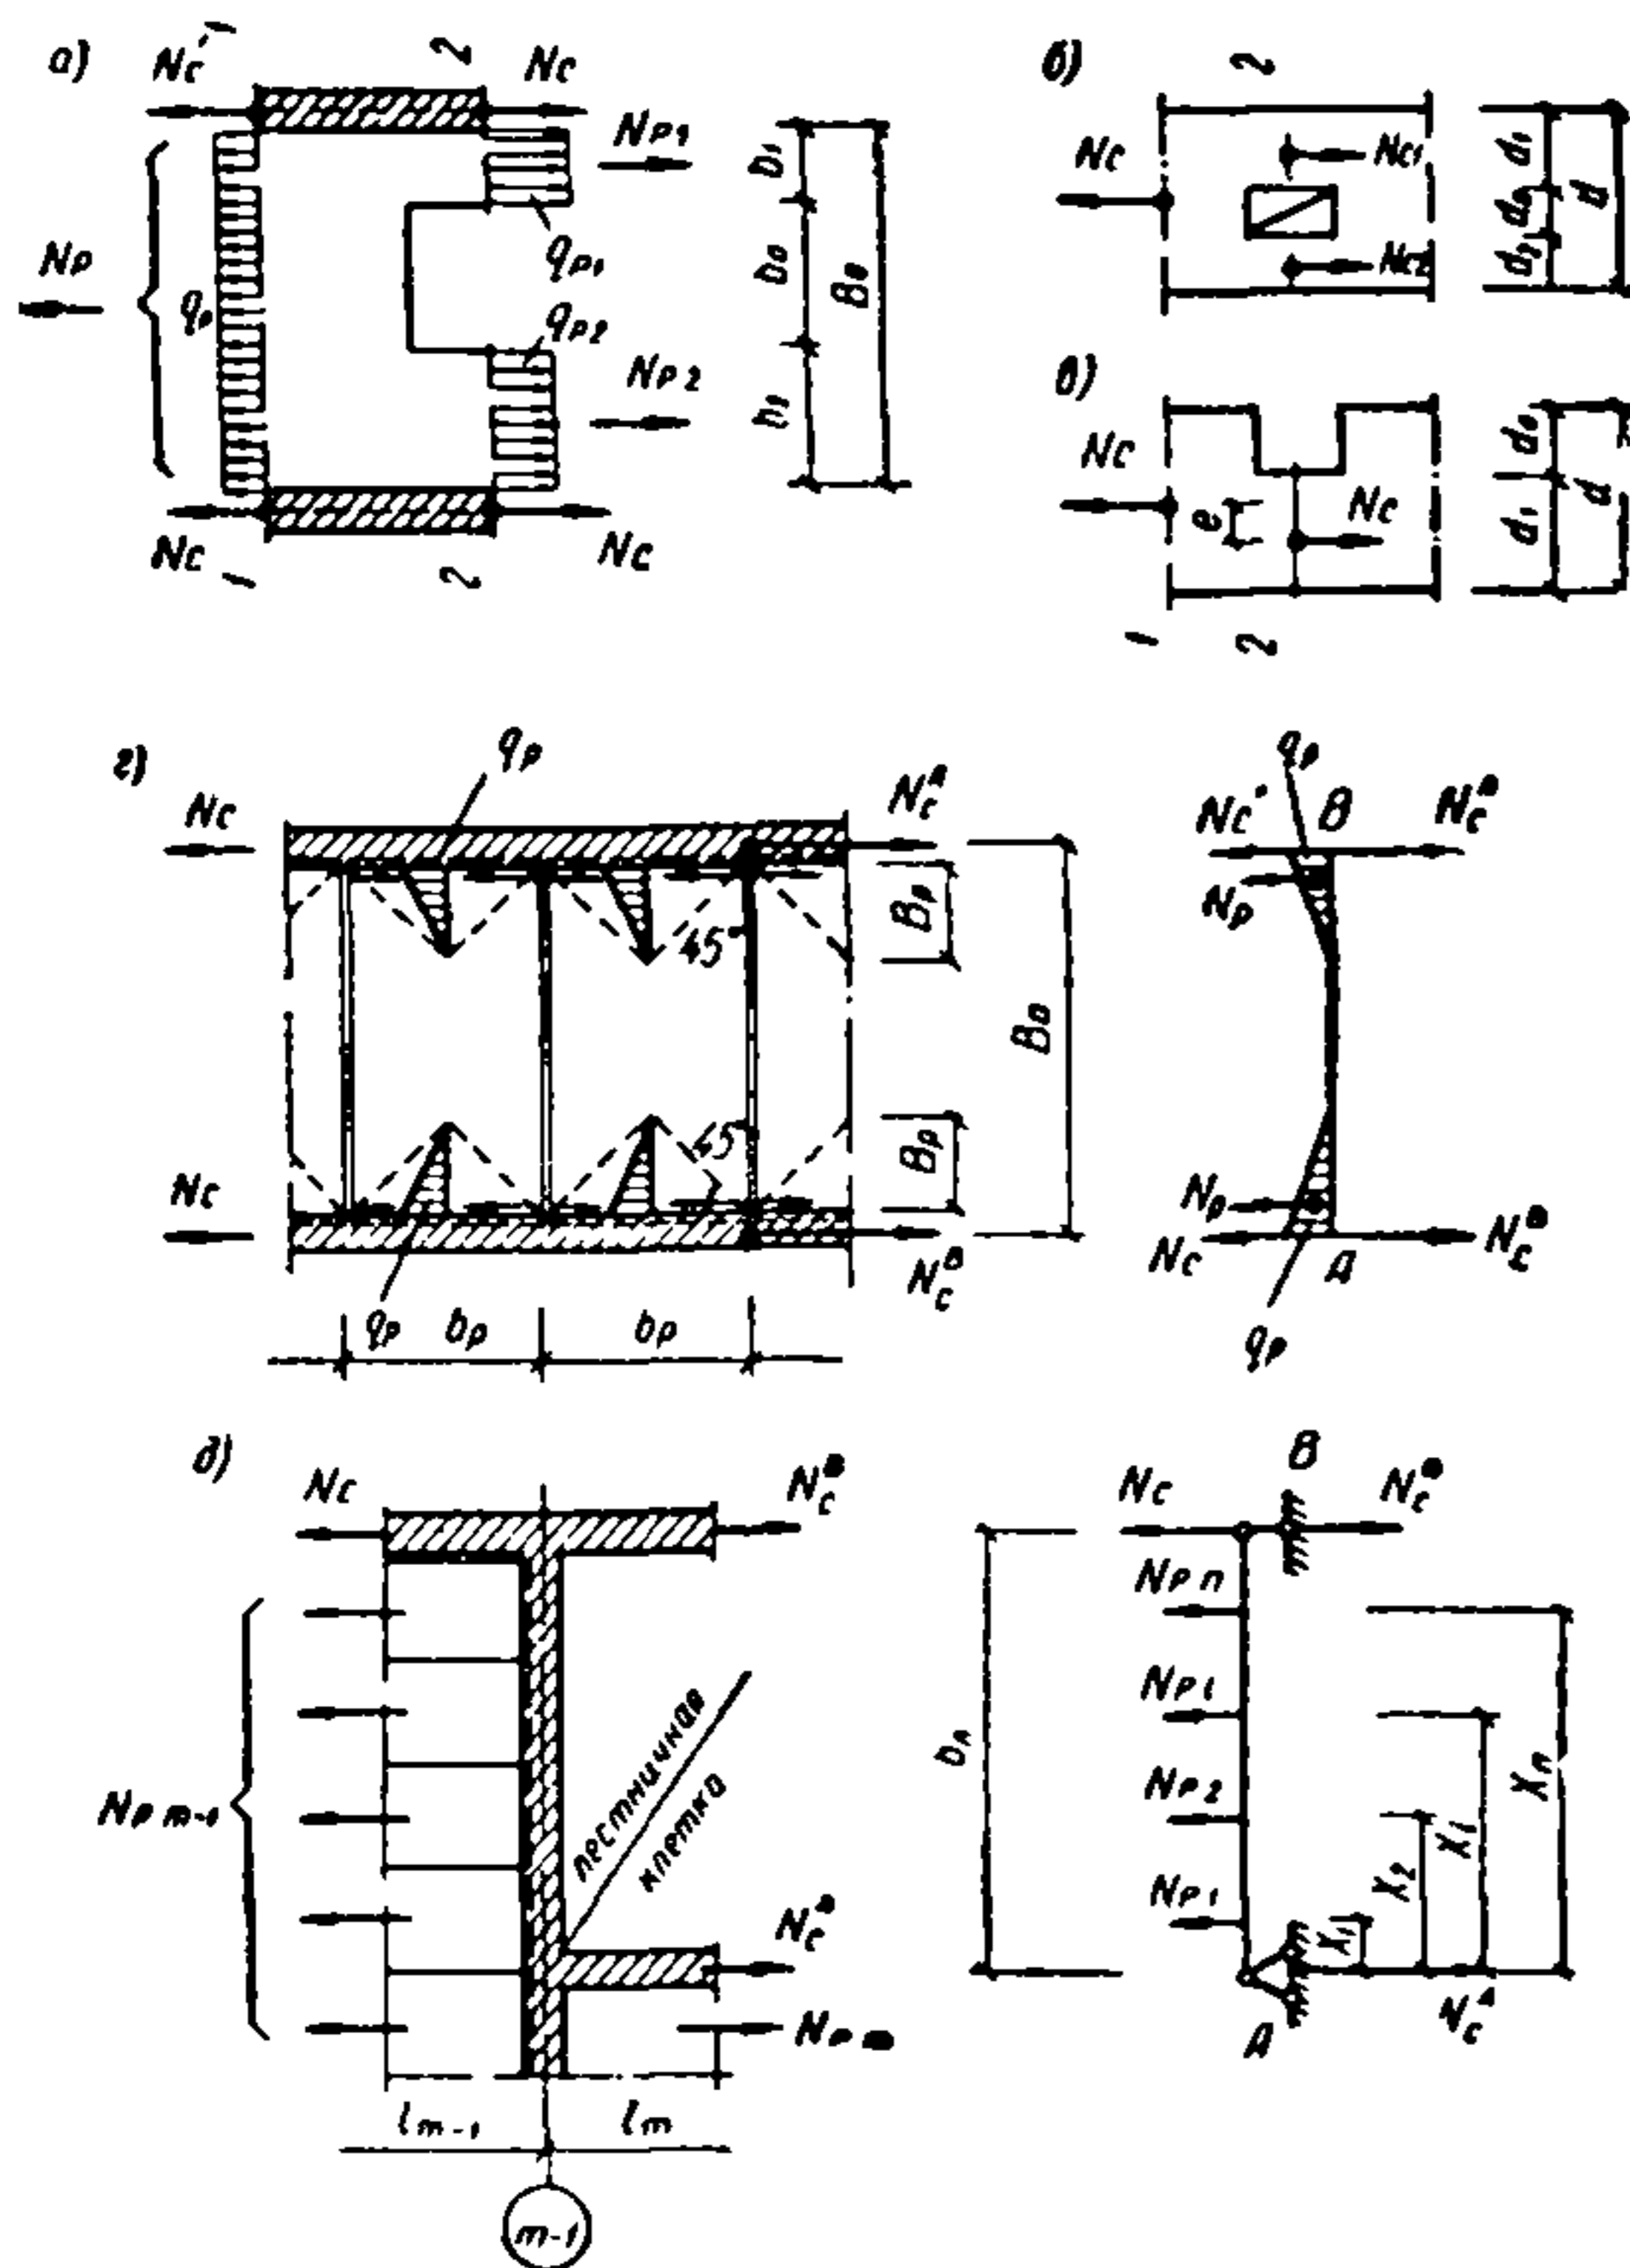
К расчету продольных усилий в стенах и перекрытиях в местах ослабления отверстиями, штрабами и швами
